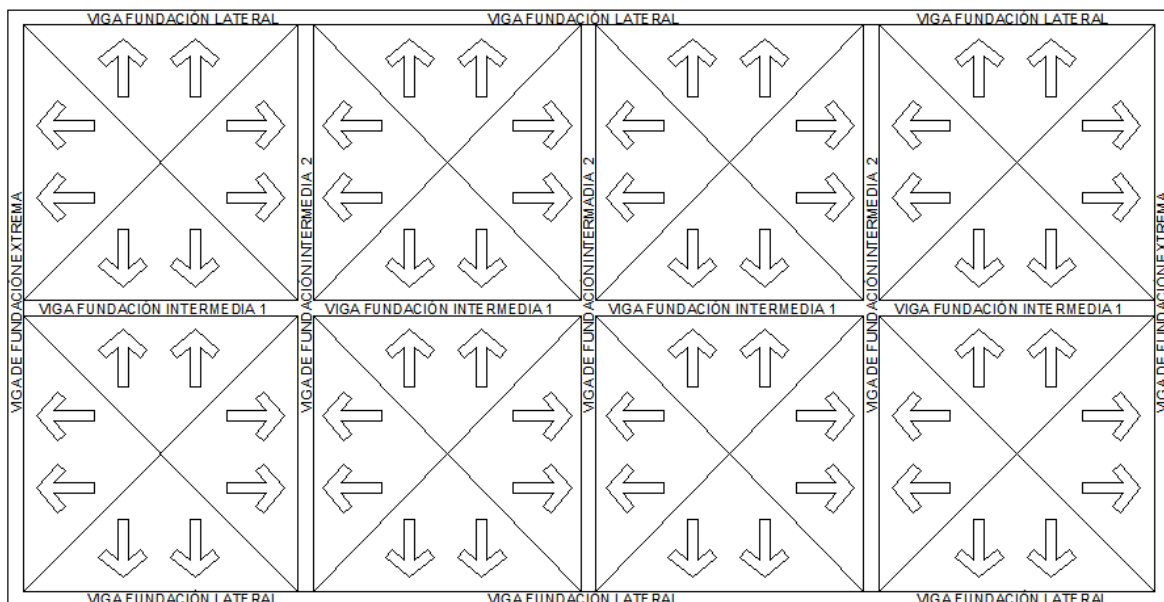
Esquema de carga en planta vigas de fundación cisterna
